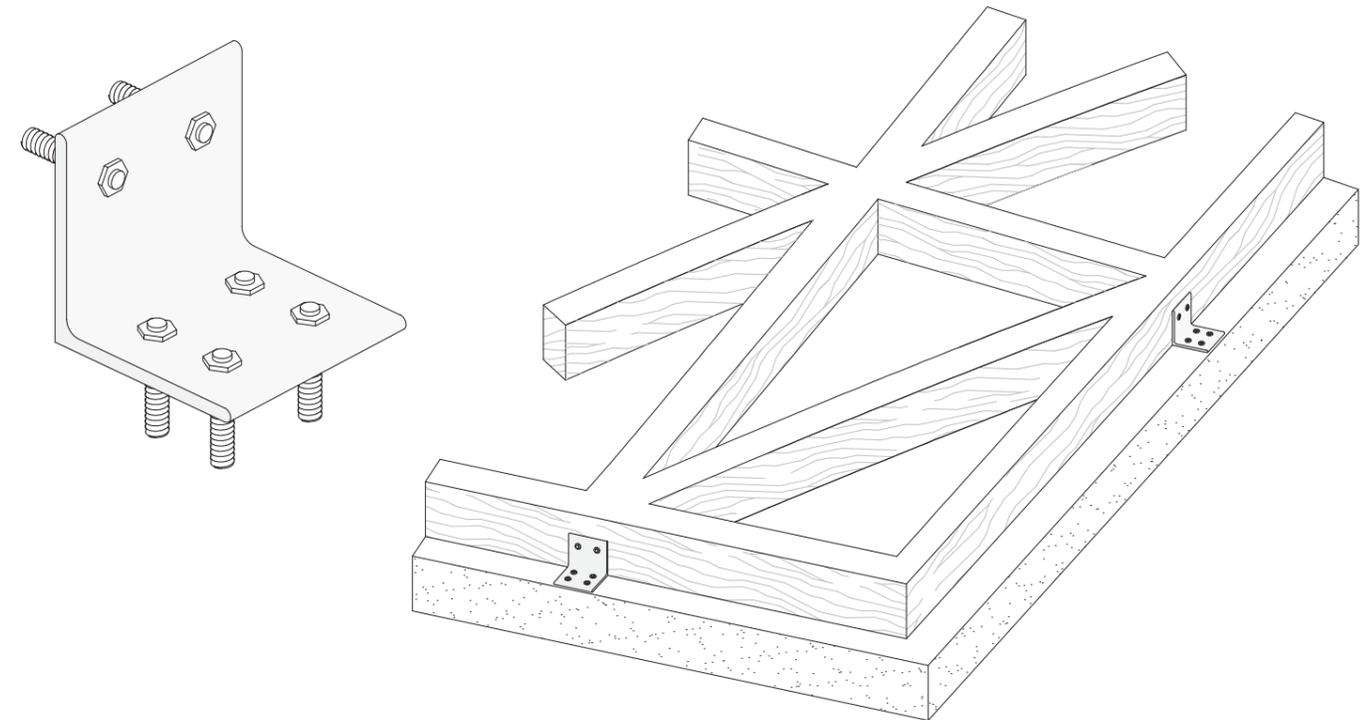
Detalle unión estructura de madera con zuncho de borde.
